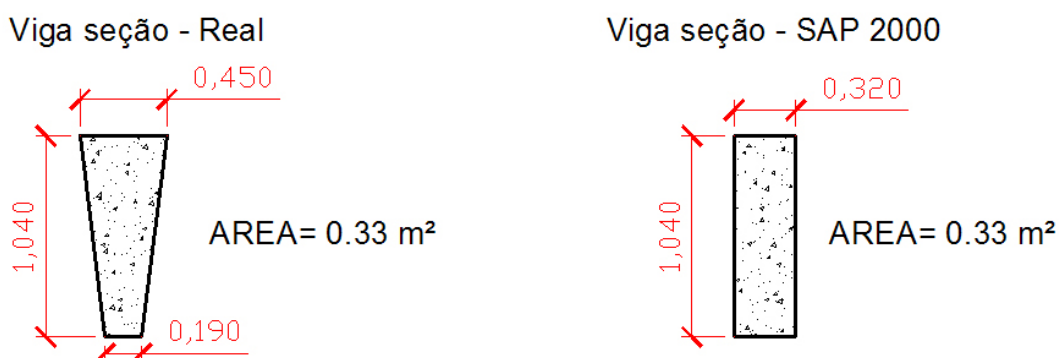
Seções transversais da viga do trecho da rua interna de pedestres (AUTOCAD, 2007 - dimensões em metros)
